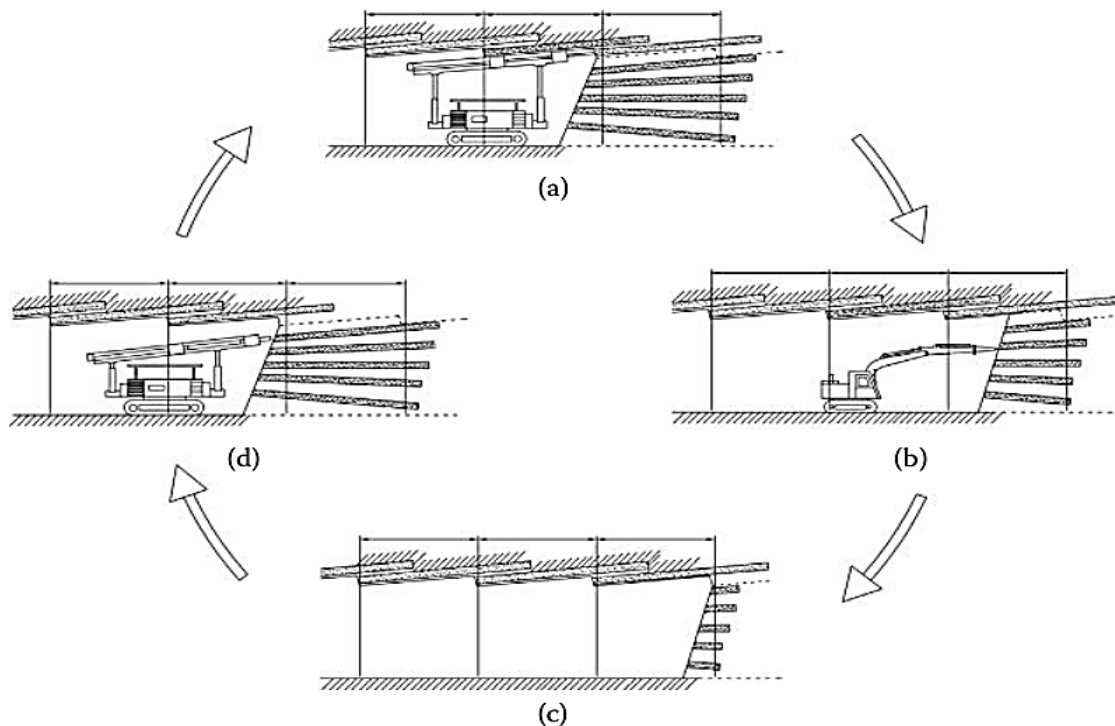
Processus de Jet Grouting pour conditionnement du terrain [53].
